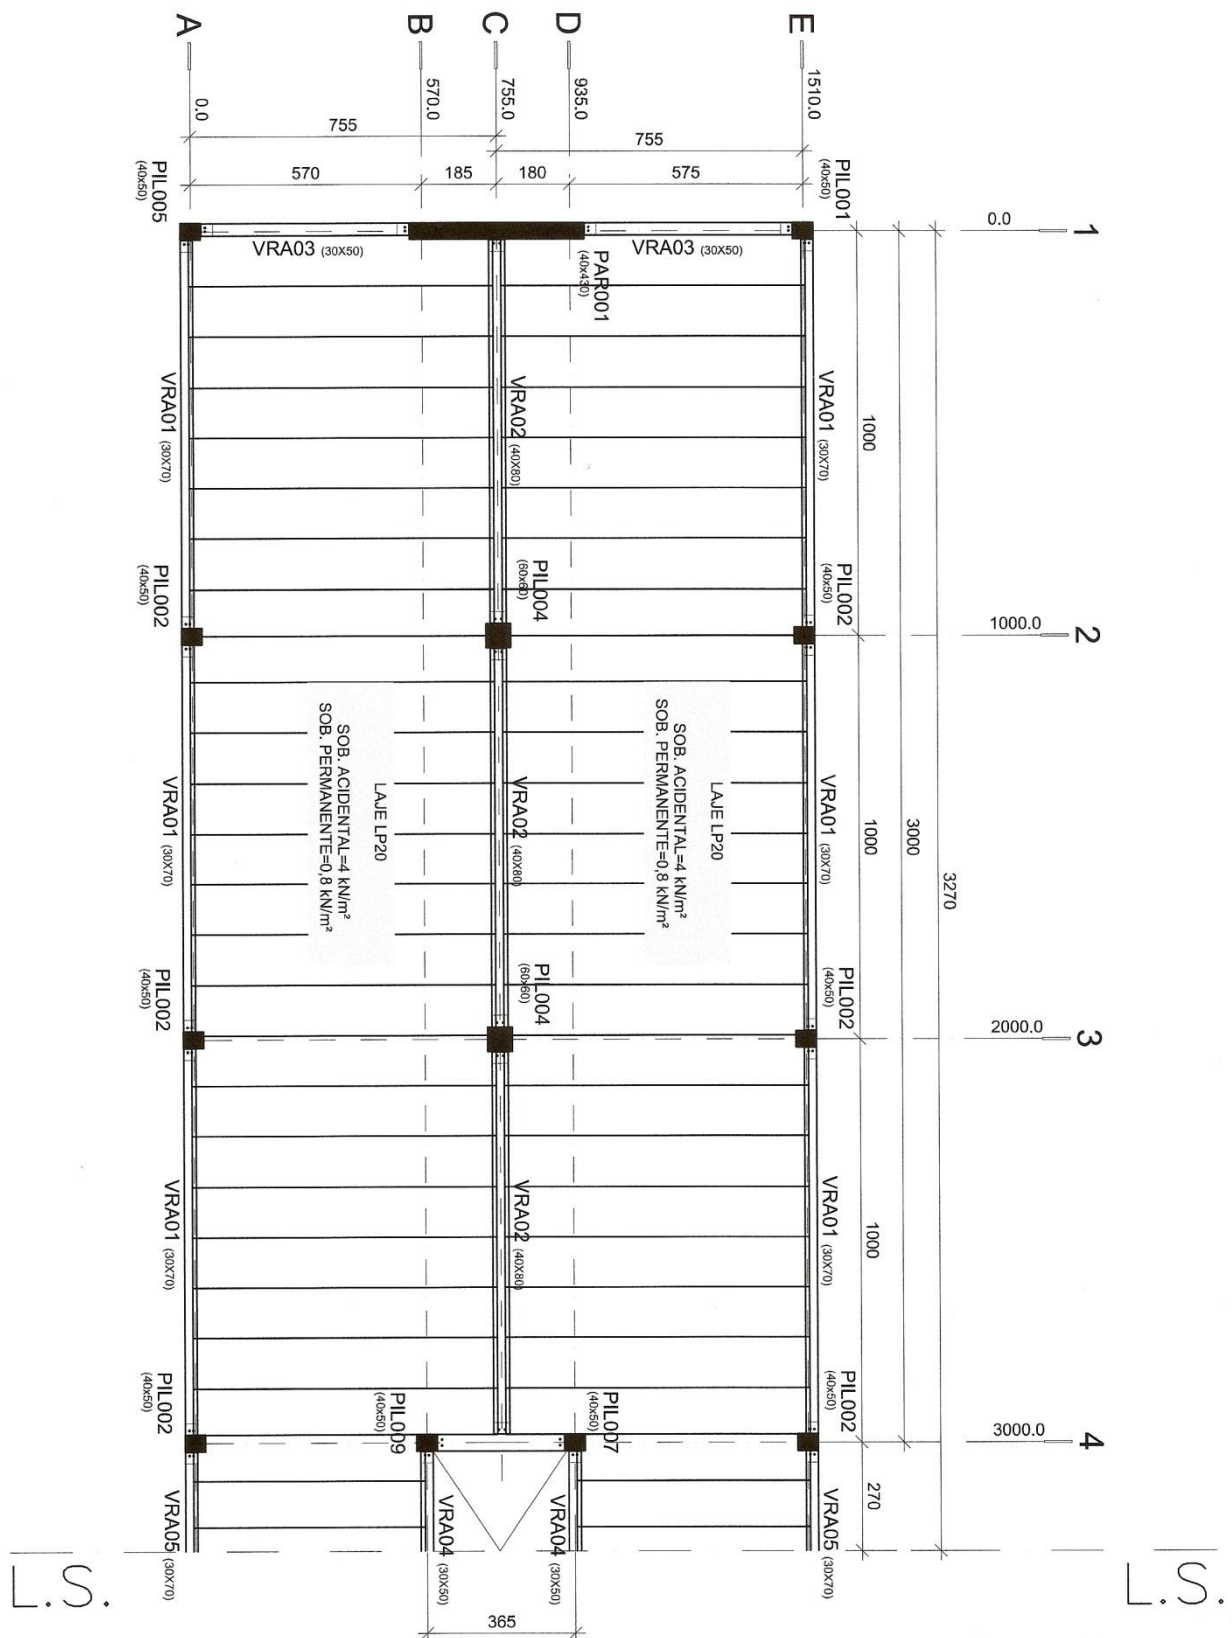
35 – Planta do pavimento tipo da estrutura do Exemplo 05.
